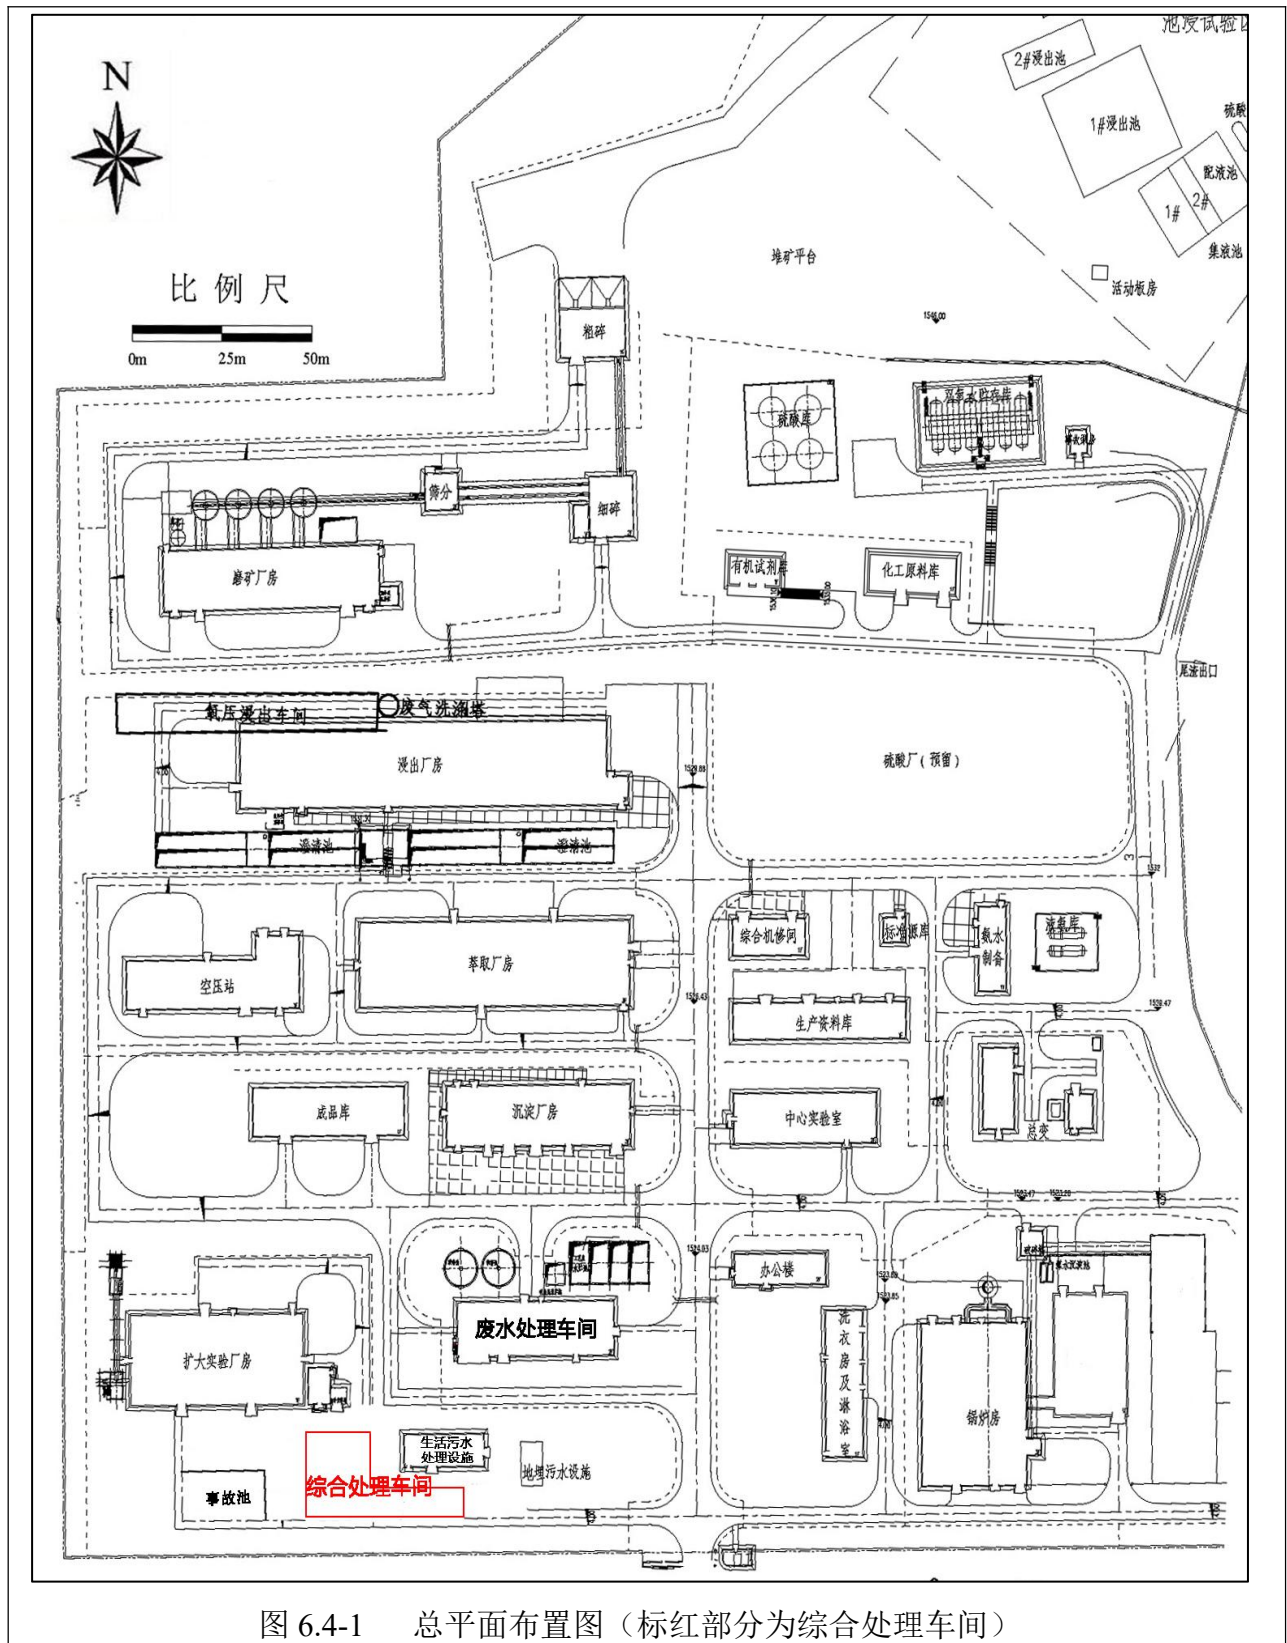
总平面布置图 (标红部分为综合处理车间)
